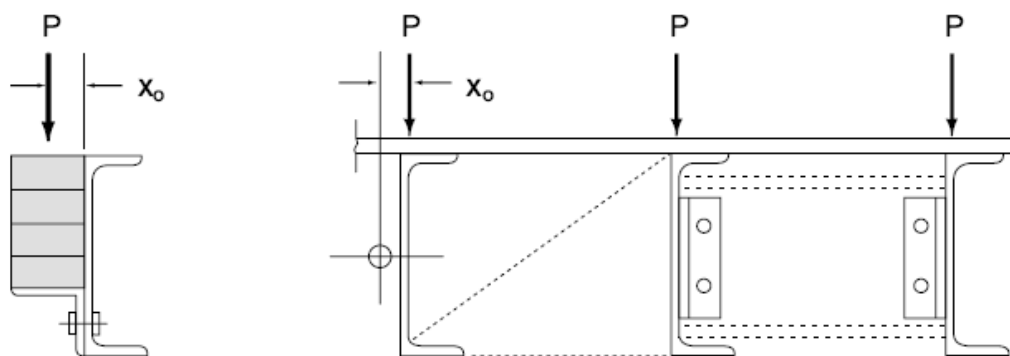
Disposiciones constructivas de vigas UPL a nivel del suelo
